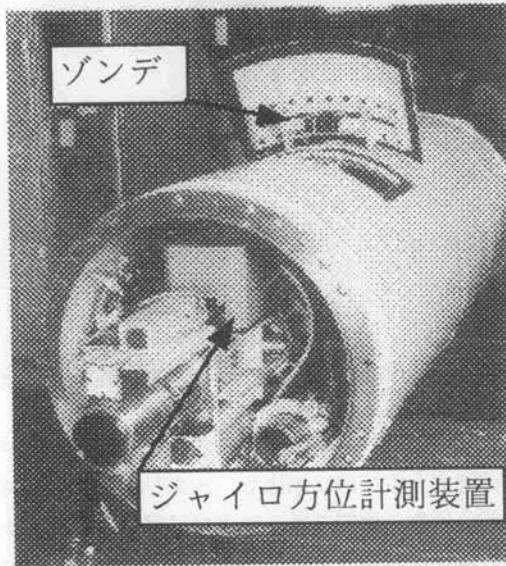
ソンデおよびジャイロ方位計測装置の掘進機内設置状況
